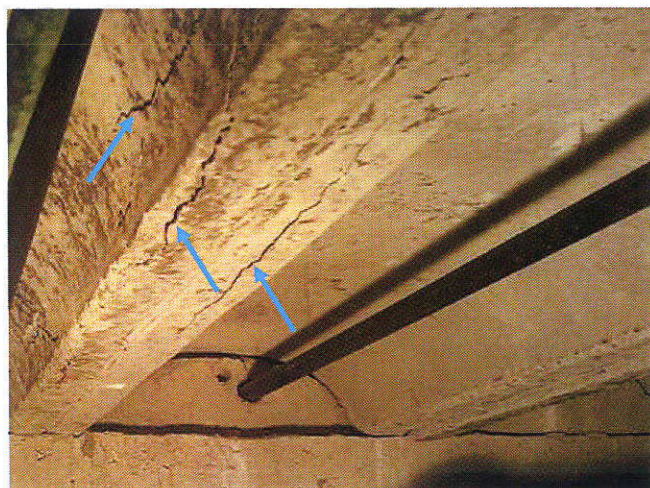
Onderzijde BG vloer met intact naspansysteem. Spankabel door kopschot. Scheurvorming beton in rib van vloerelement.
